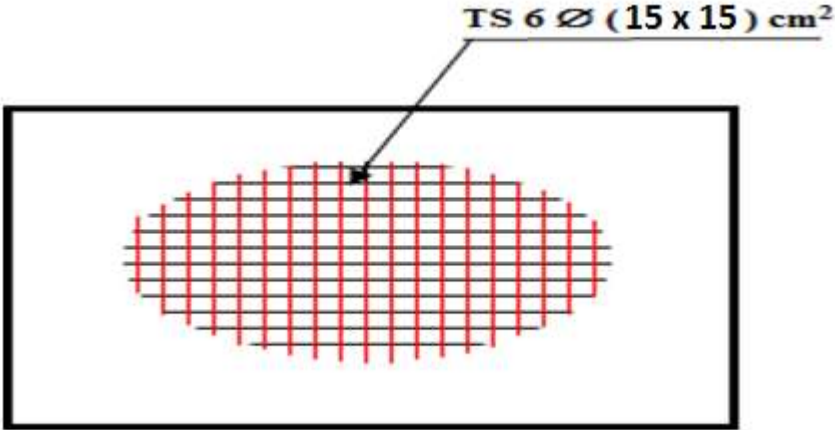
schéma de Ferrailage du plancher à corps creux.
